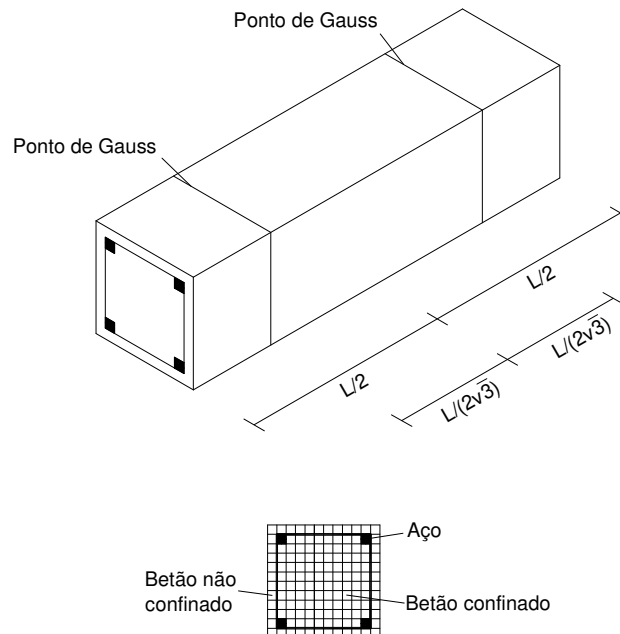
Discretização dos elementos e das secções de betão armado num modelo de fibras
